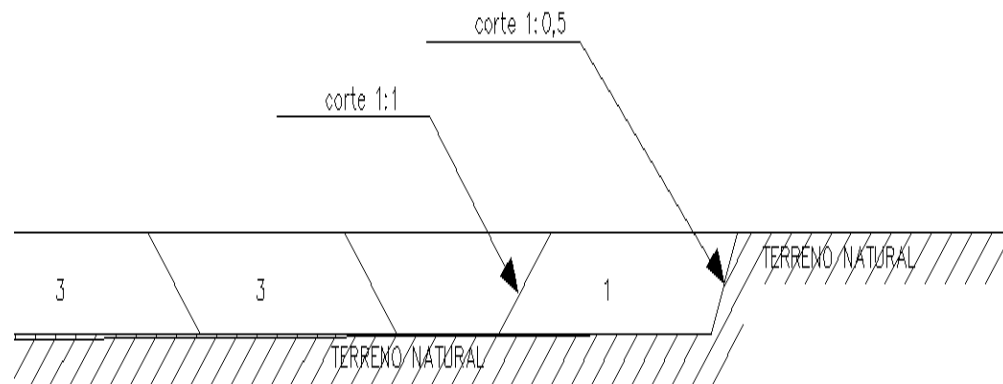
Detalle de la primera zona de excavación (zona de Zanja)
